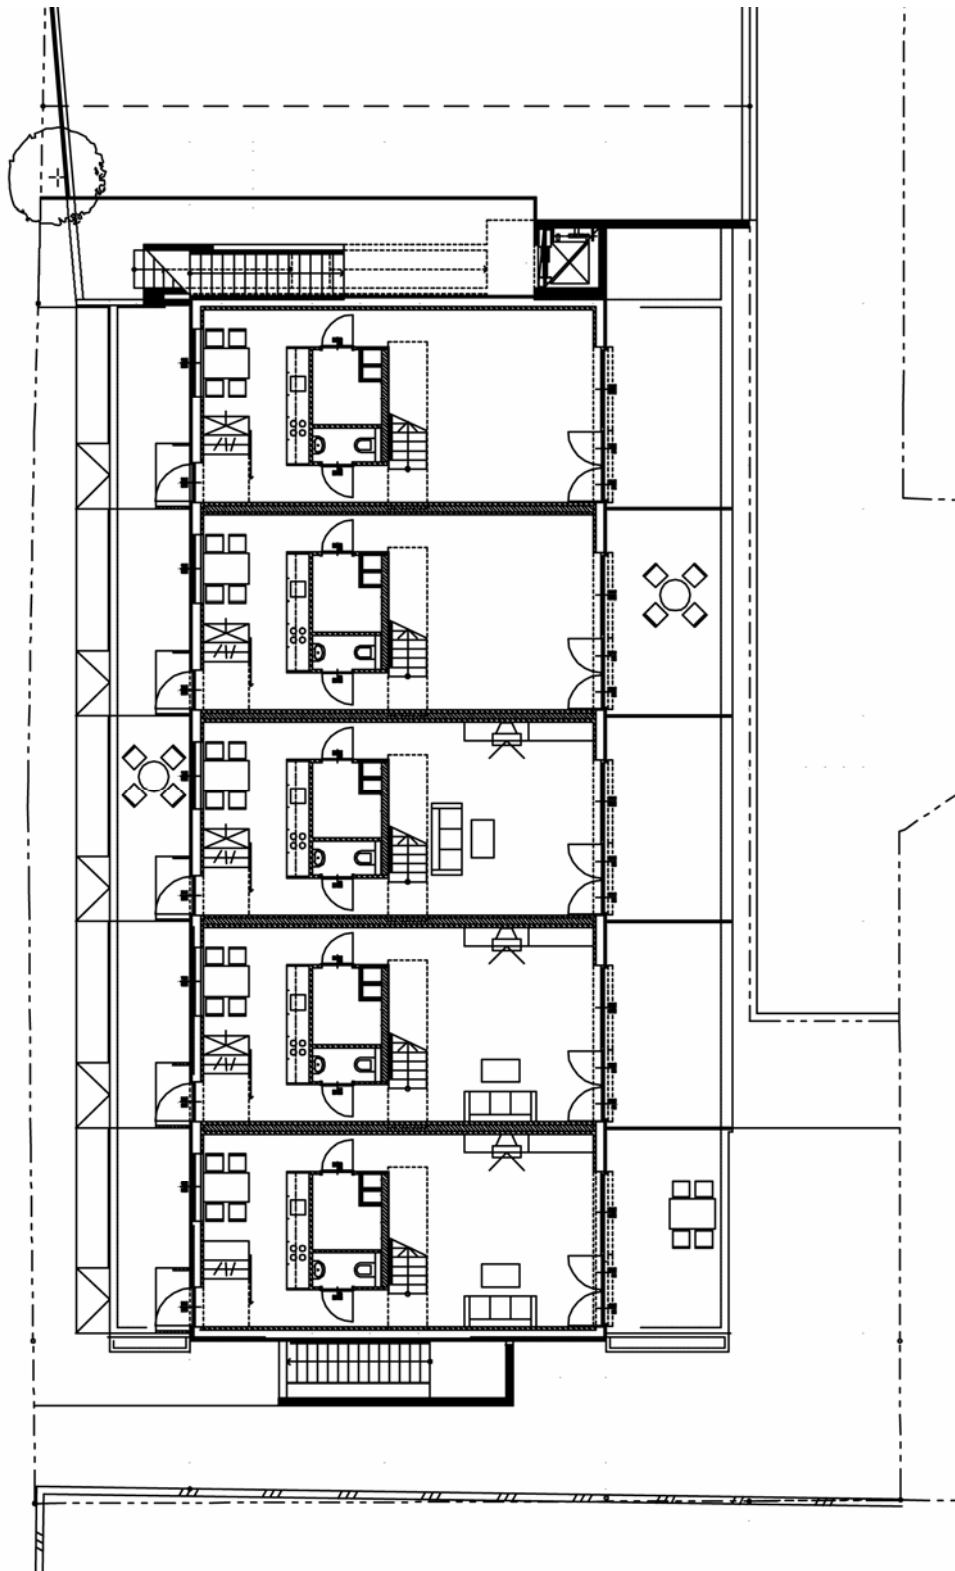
Grundriss EG Projekt "Smart Housing" M 1:200
